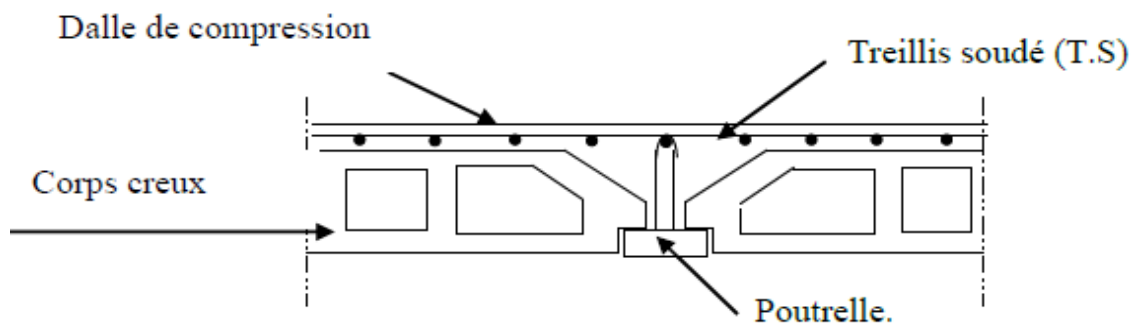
Schéma descriptif d'un plancher courant.
